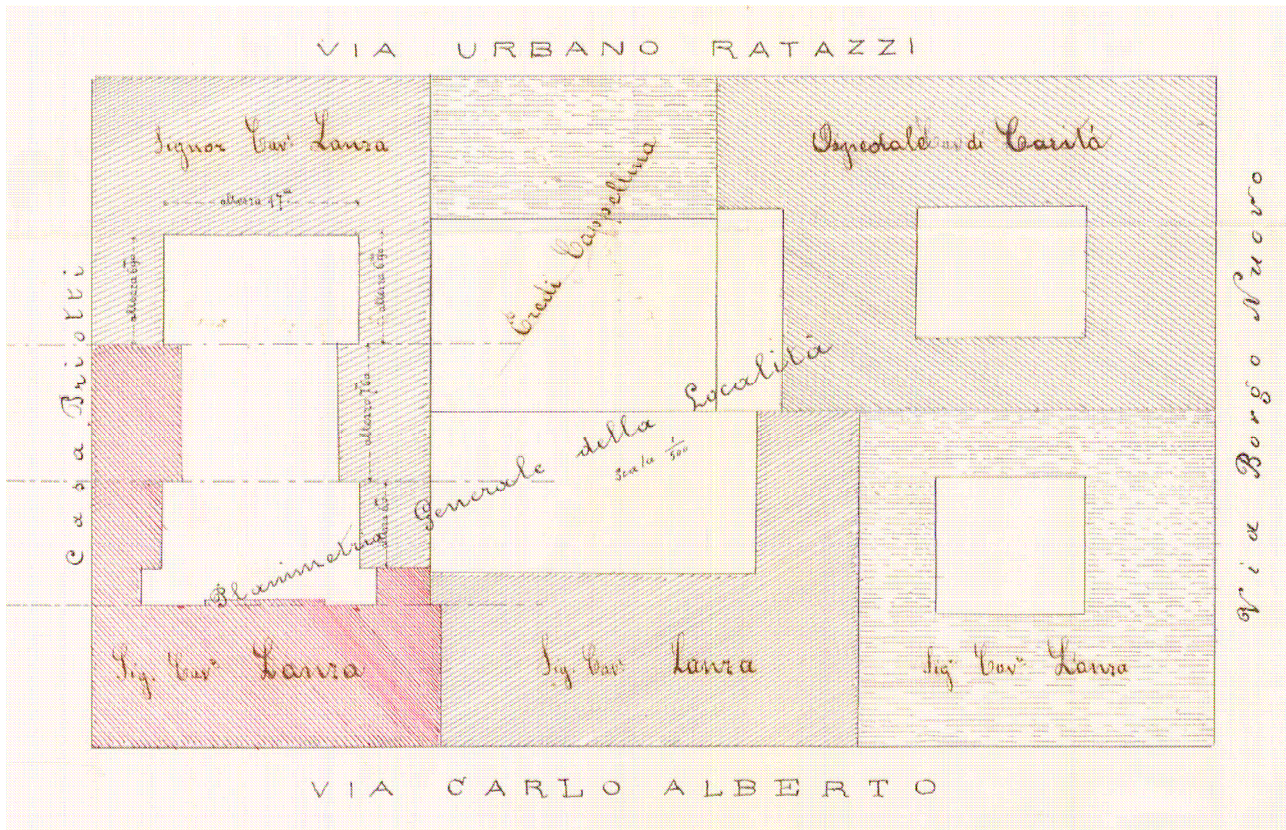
Antonio Debernardi - Planimetria generale di Palazzo Lanza, 1881
